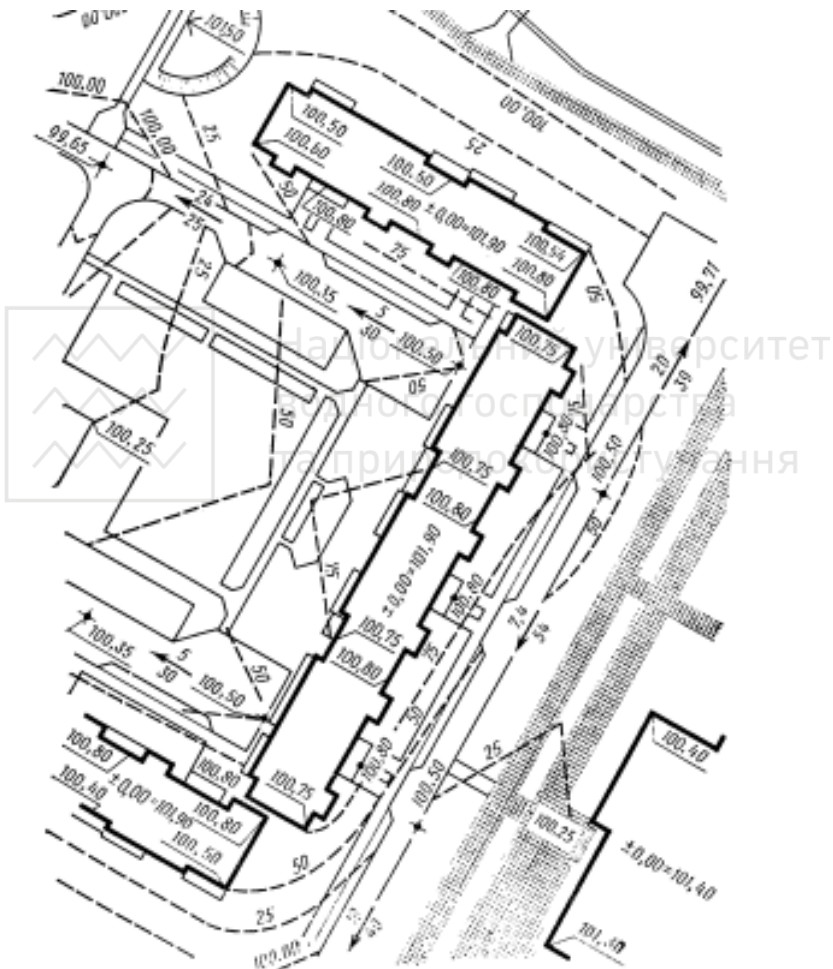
Фрагмент вертикального планування території житлової забудови
